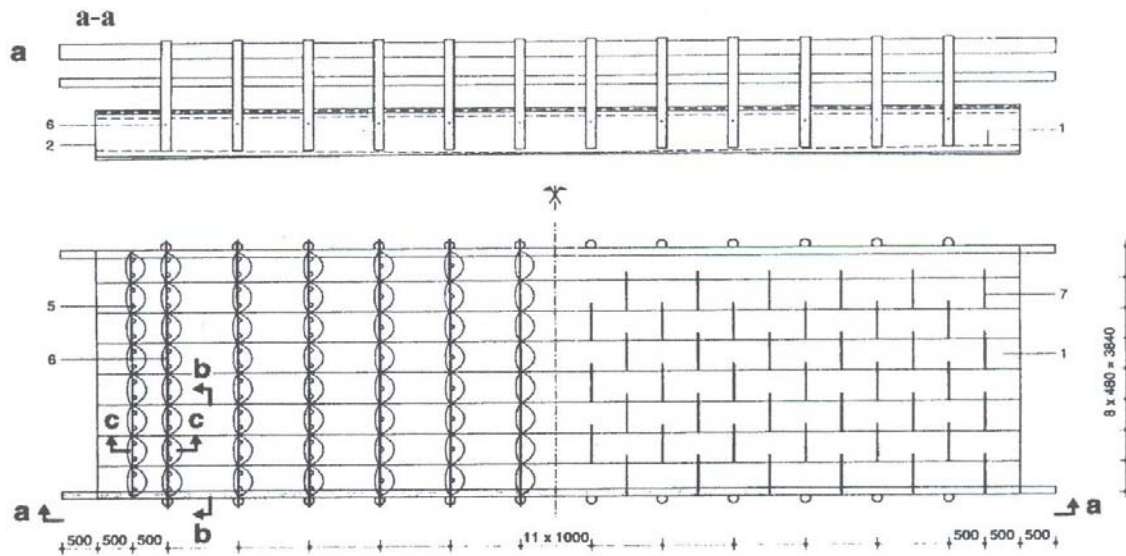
Planta e corte esquemático a-a, da ponte em placa no sistema apresentado.
